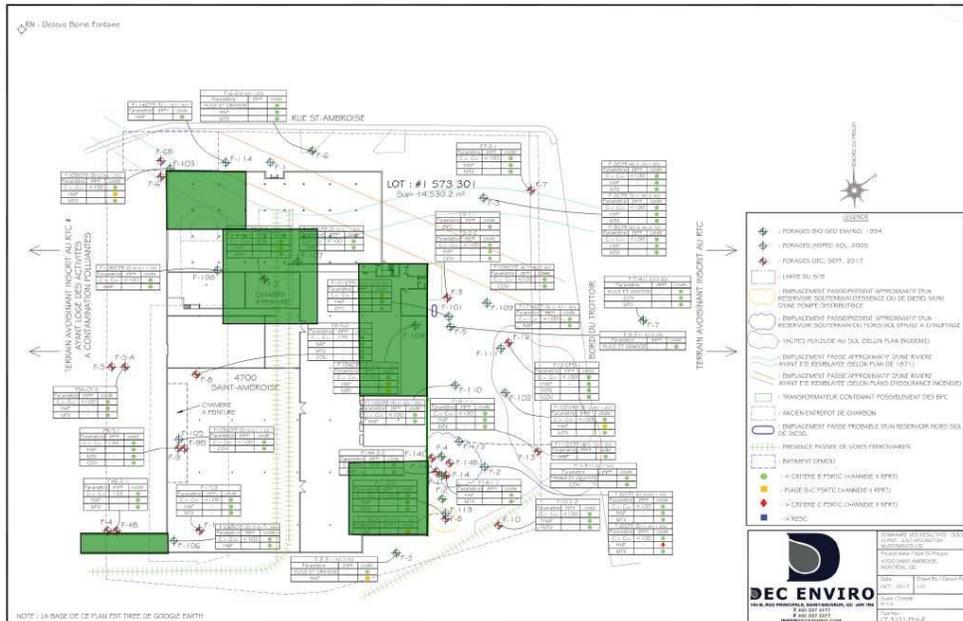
Section de plancher à retirer pour décontamination (en vert)
